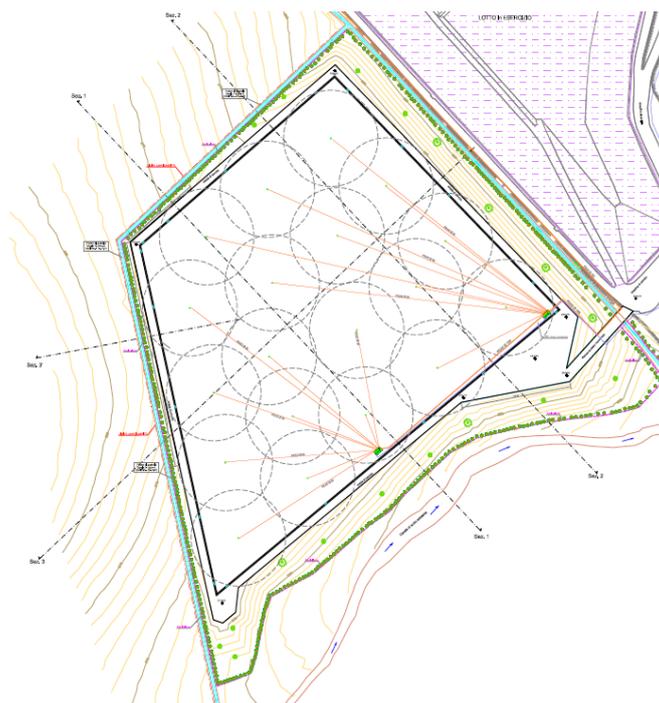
stralcio grafico tratto da Tav. 2.09 – Planimetria captazione del biogas Lotto A
